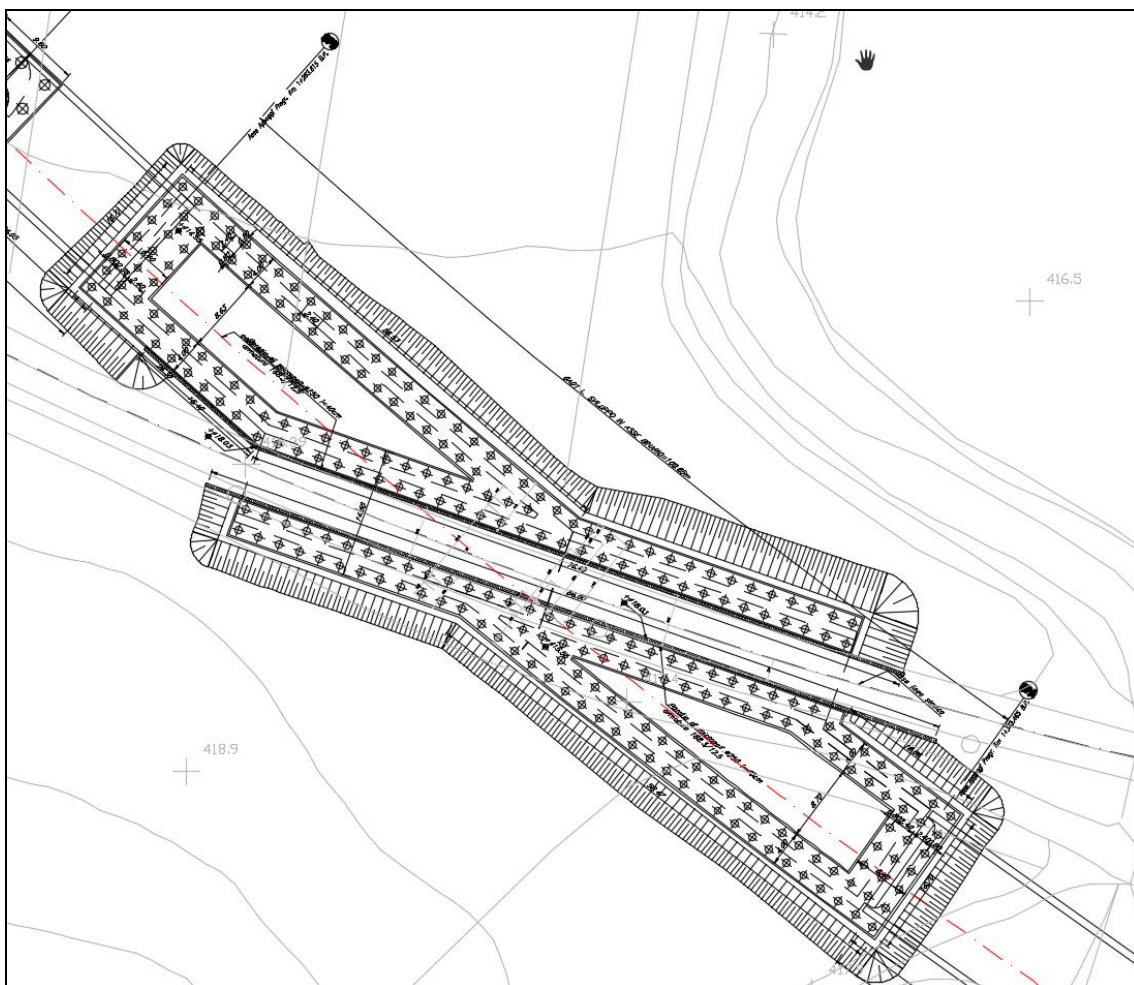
galleria artificiale GA01 lotto 3 (stralcio planimetrico)
